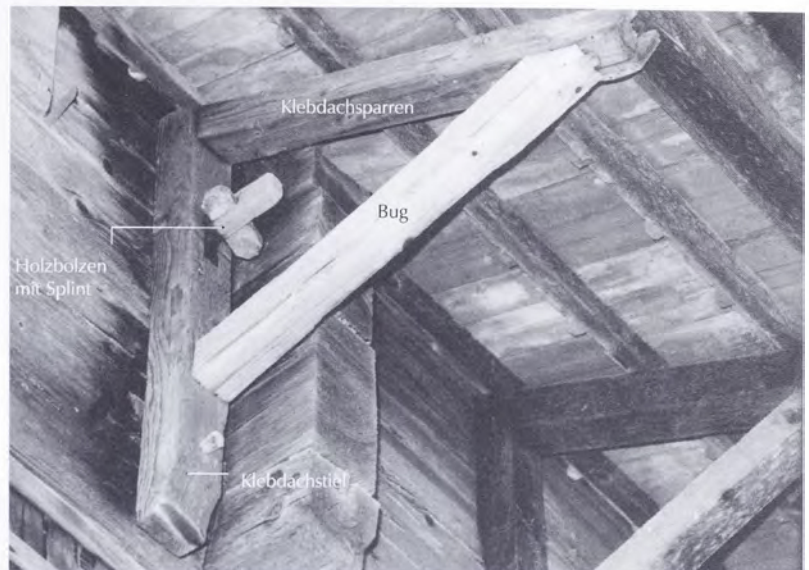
Klebdach, Konstruktion mit Klebdachstiel.
